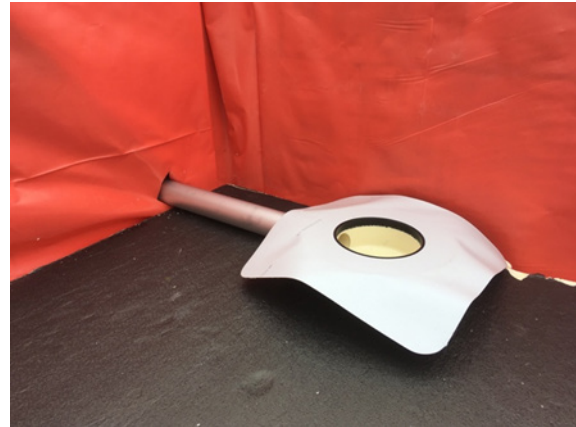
Entwässerungstopf mit Kunststoffflansch auf Grunddämmung-Dachaufbau – der Durchstoßpunkt ist hier noch nicht eingeklebt
